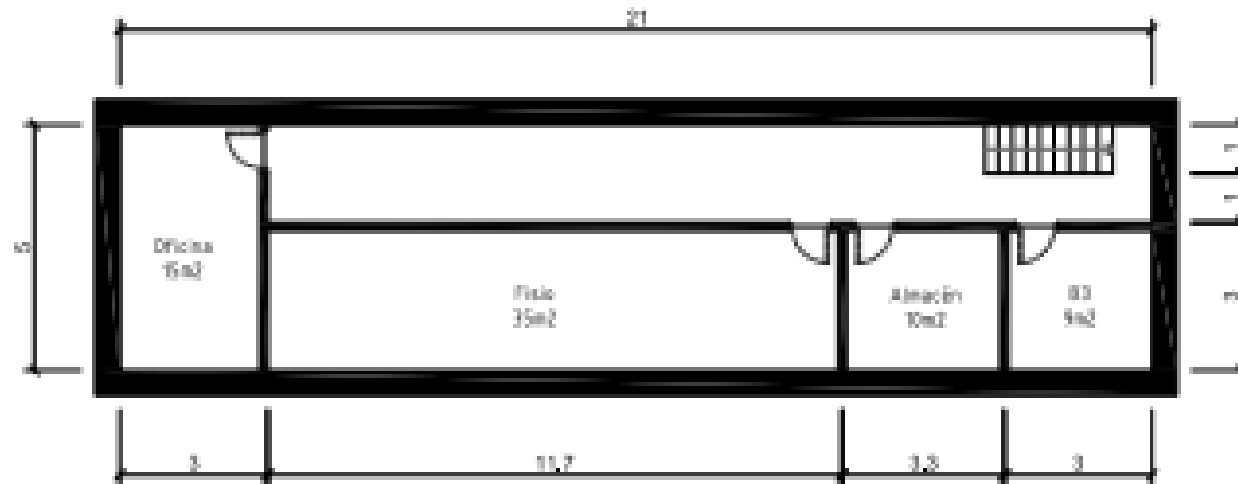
Plano planta alta. <<Fuente. Elaboración propia>>
